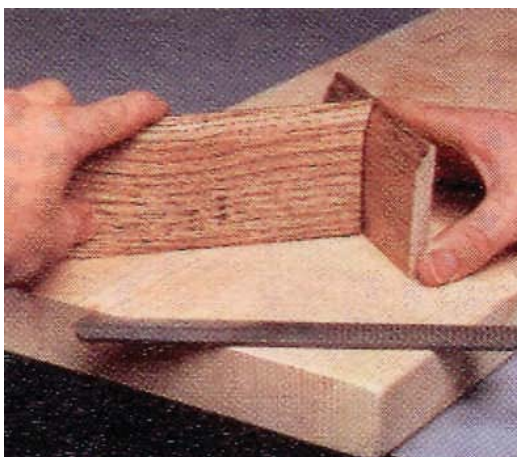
10: Utilizando el pantógrafo para determinar la forma que debe tener el corte de la moldura.
